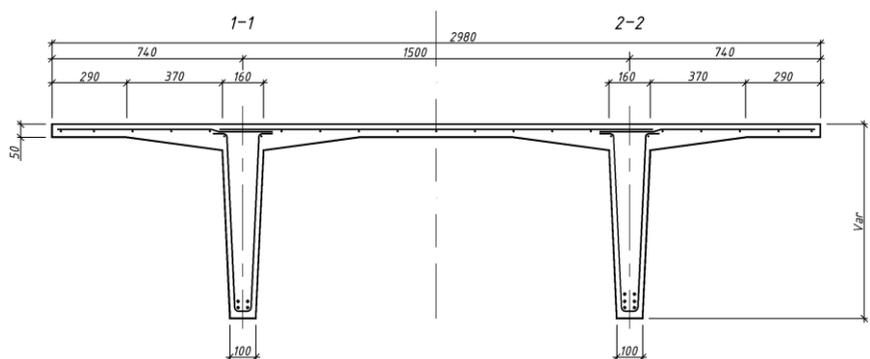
Поперечное сечение малоуклонных плит 2Т
